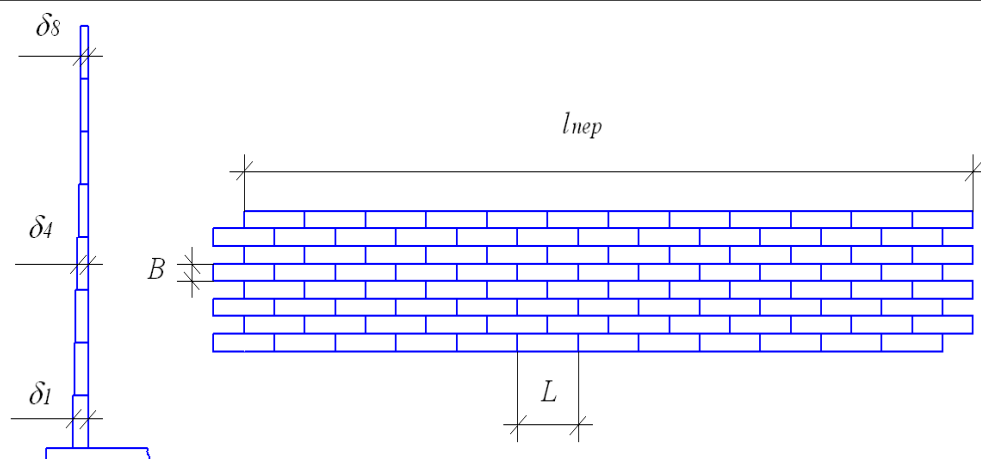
Развертка и сечение стенки вертикального резервуара[25]
